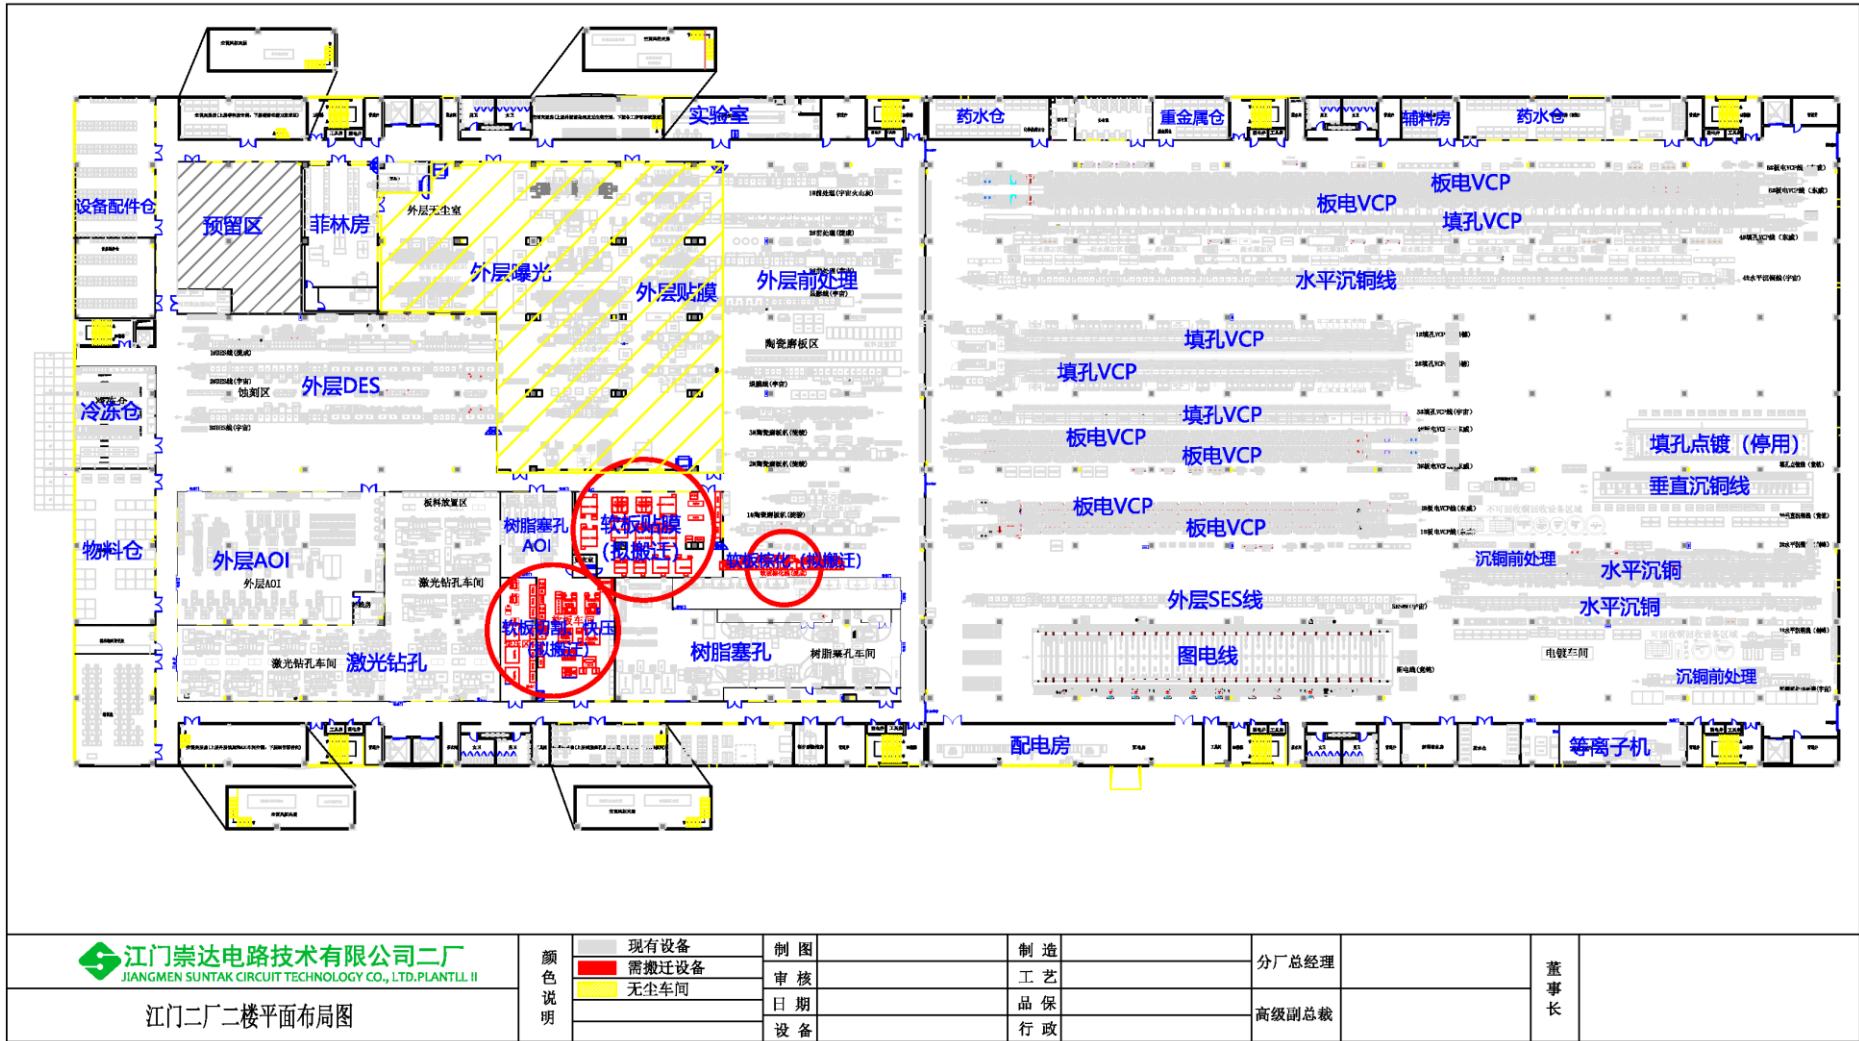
(e) 现有项目厂房二 2F 车间平面布置图
